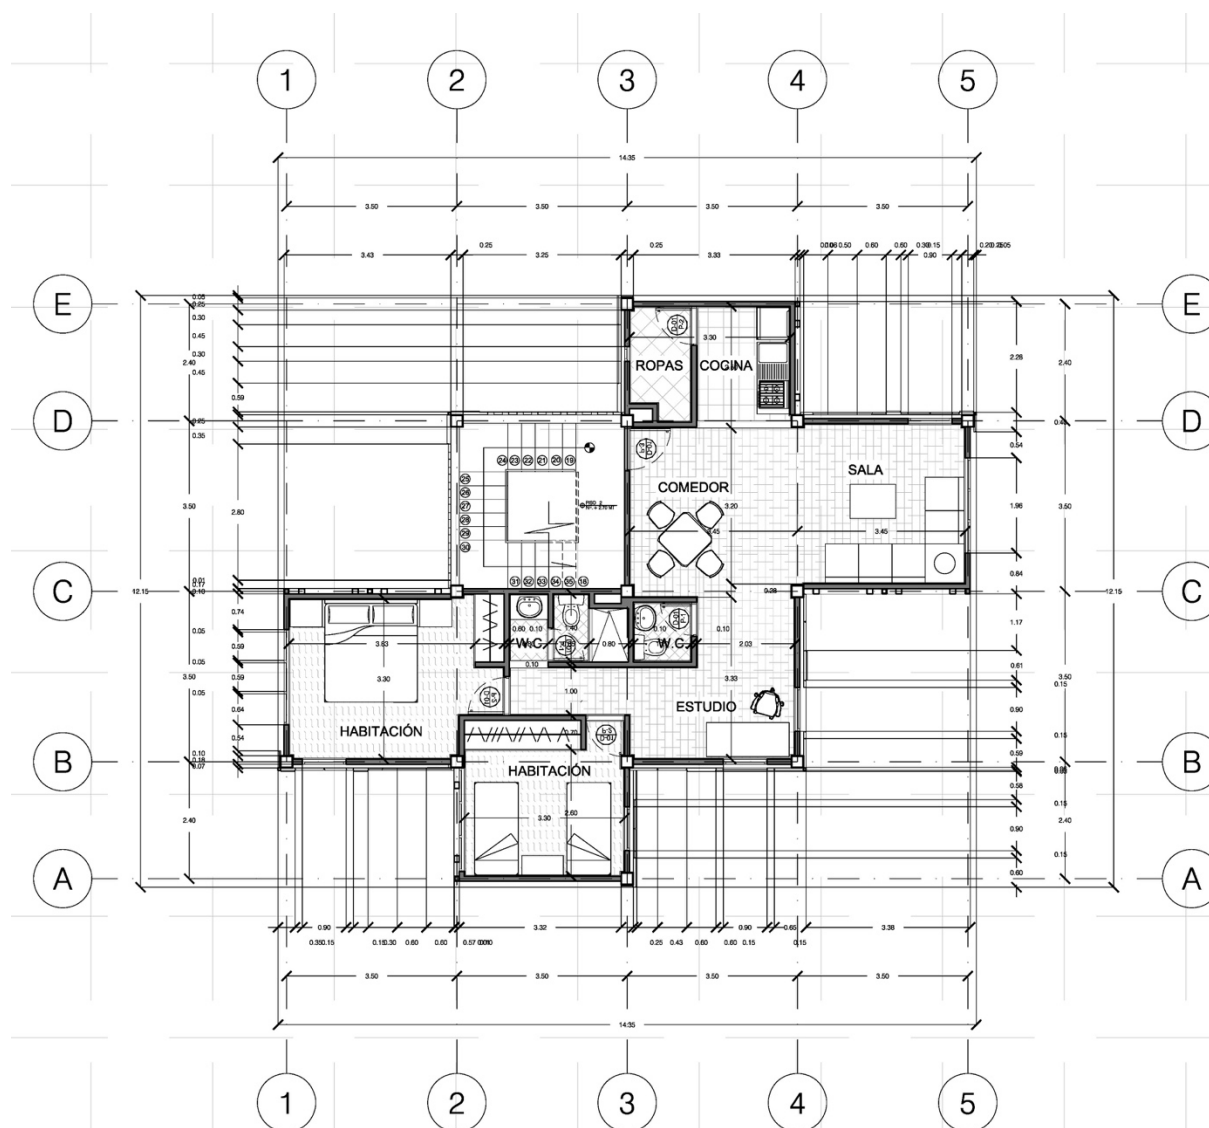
Planta arquitectónica segundo piso, Módulo de vivienda inicial (Elaboración del autor)
